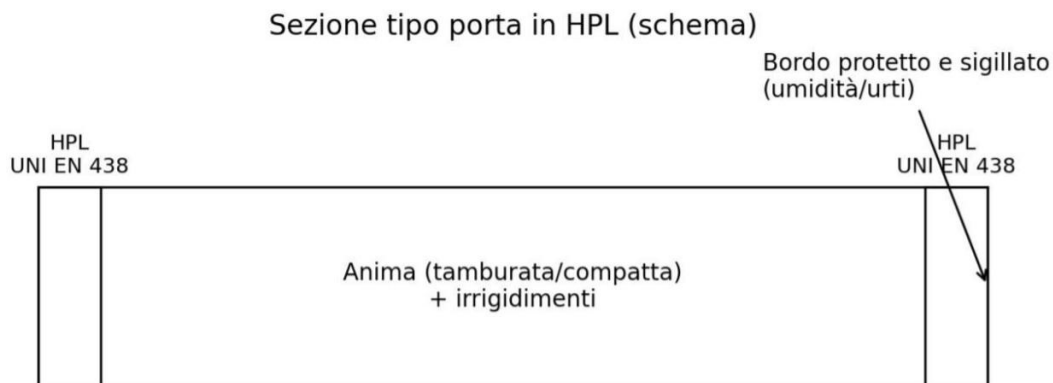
Sezione tipo porta in HPL (schema esplicativo).
